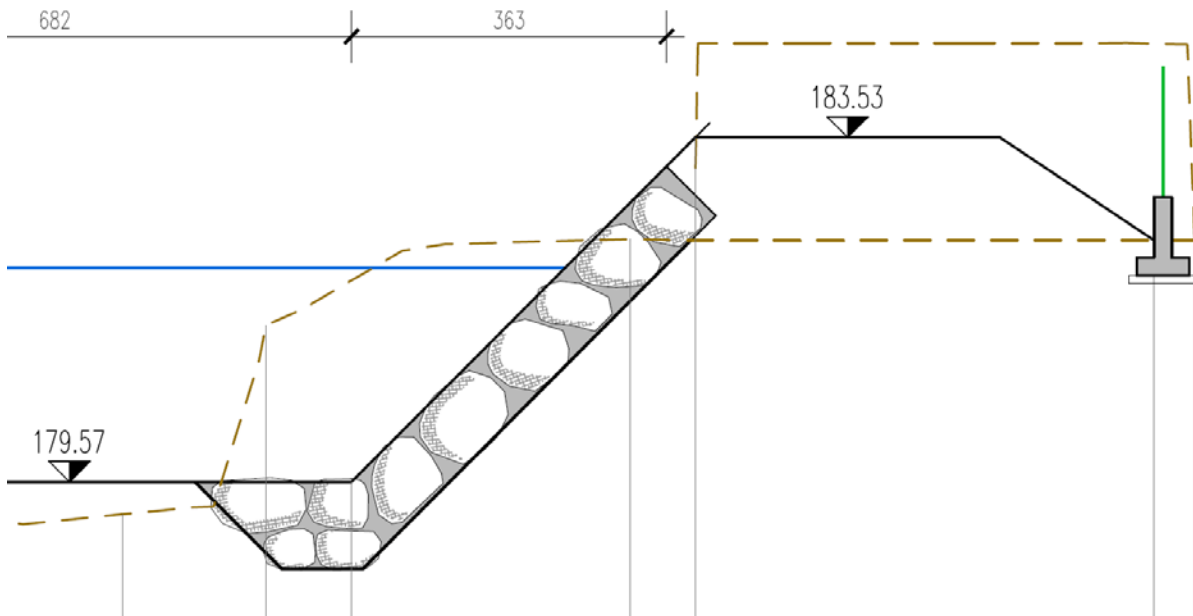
Estratto Tavola 07. Sezione dell'argine in corrispondenza della particella 479: sarà realizzato un muretto di confine con recinzione al piede dell'argine.
